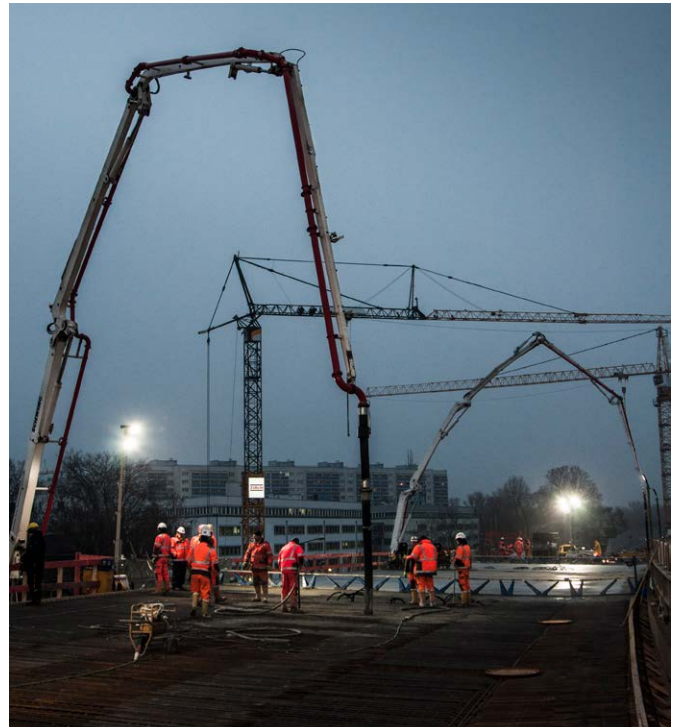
Betonage Hochstraßenbrücke Überbau 2. Bauabschnitt,
